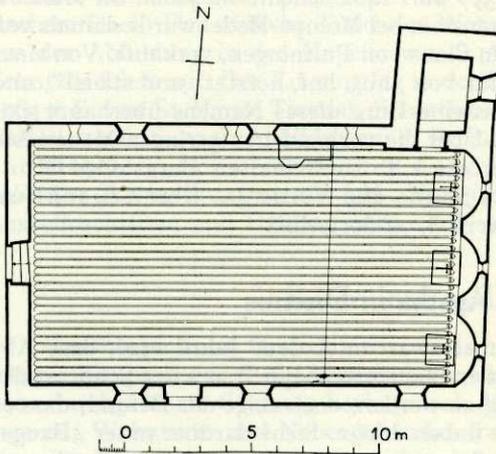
Grundriss. Maßstab 1:300.
